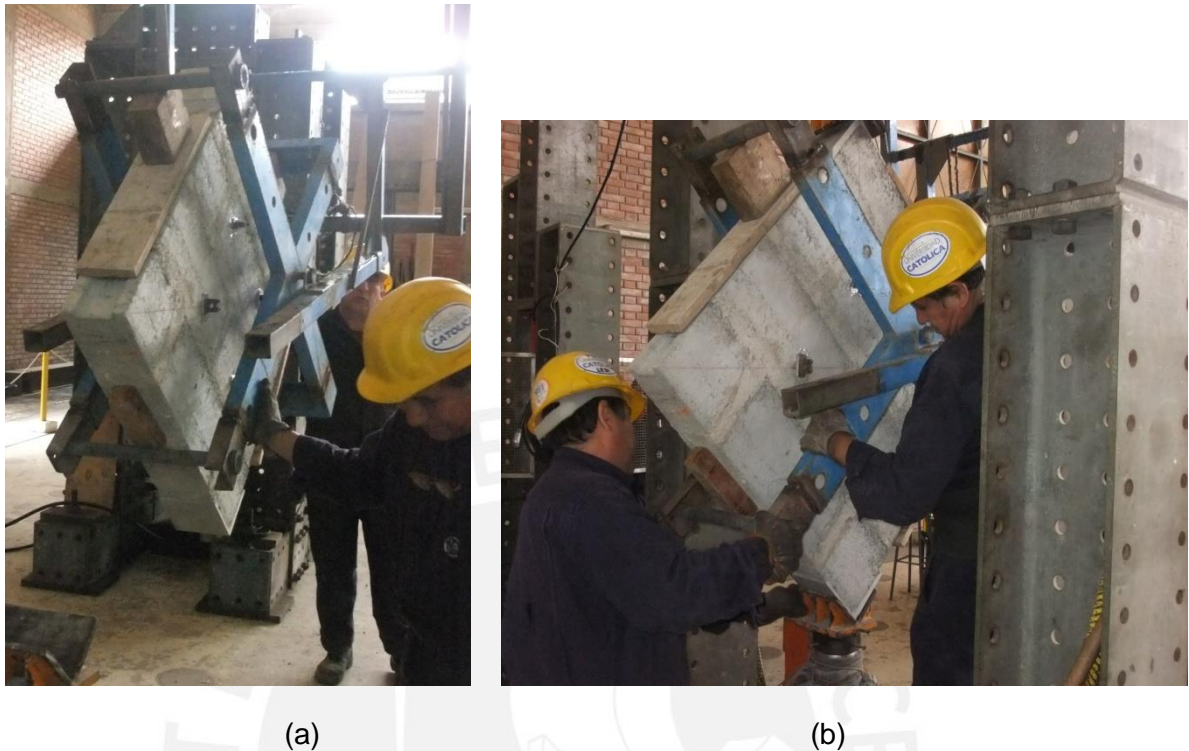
(a) Traslado del murete al dispositivo de ensayo. (b) Instalación del murete en el dispositivo de ensayo.
